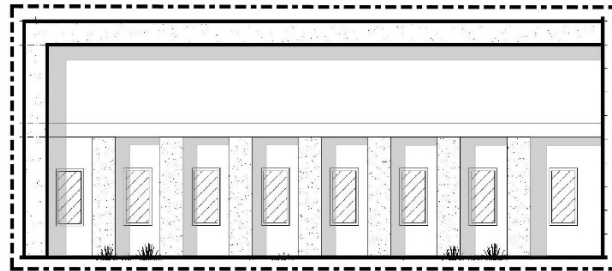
Sección de parasoles de la Elevación norte del recinto. Fuente tipo. Sin escala.
